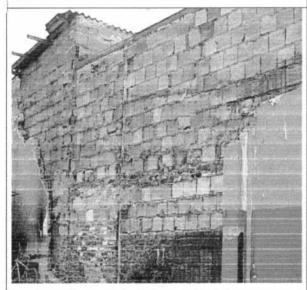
Vista exterior del muro del costado oriental del inmueble, sin ningún tipo de amarre estructural.
